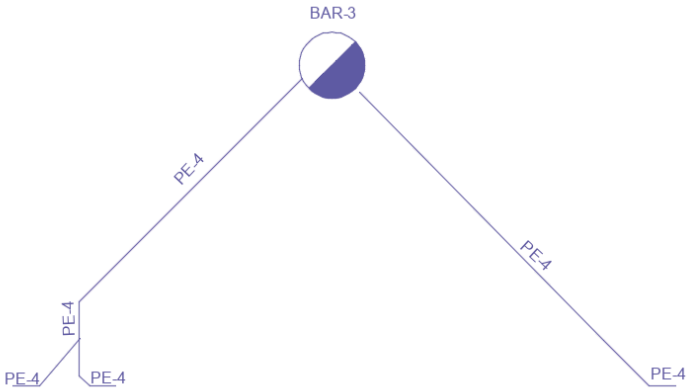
Red de PE de consultas situadas en la zona norte de la planta baja.
